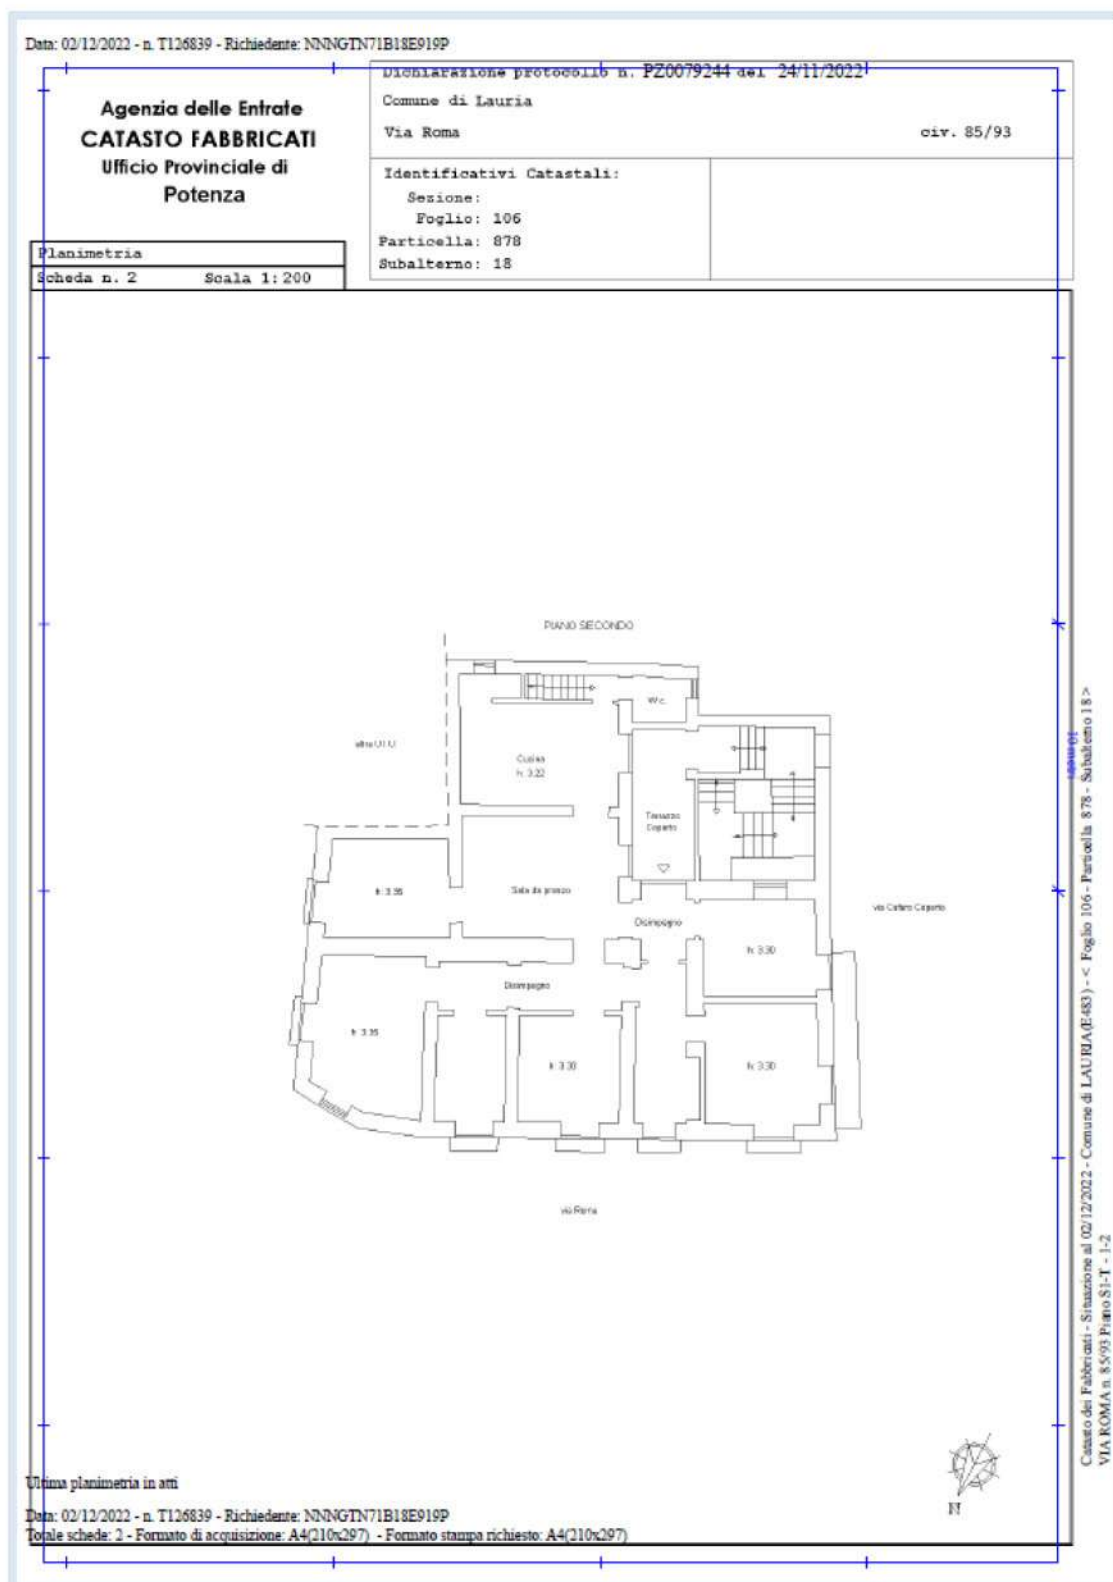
Planimetria “aggiornata” Unità Fig. 106 P.IIa 878 sub. 18
